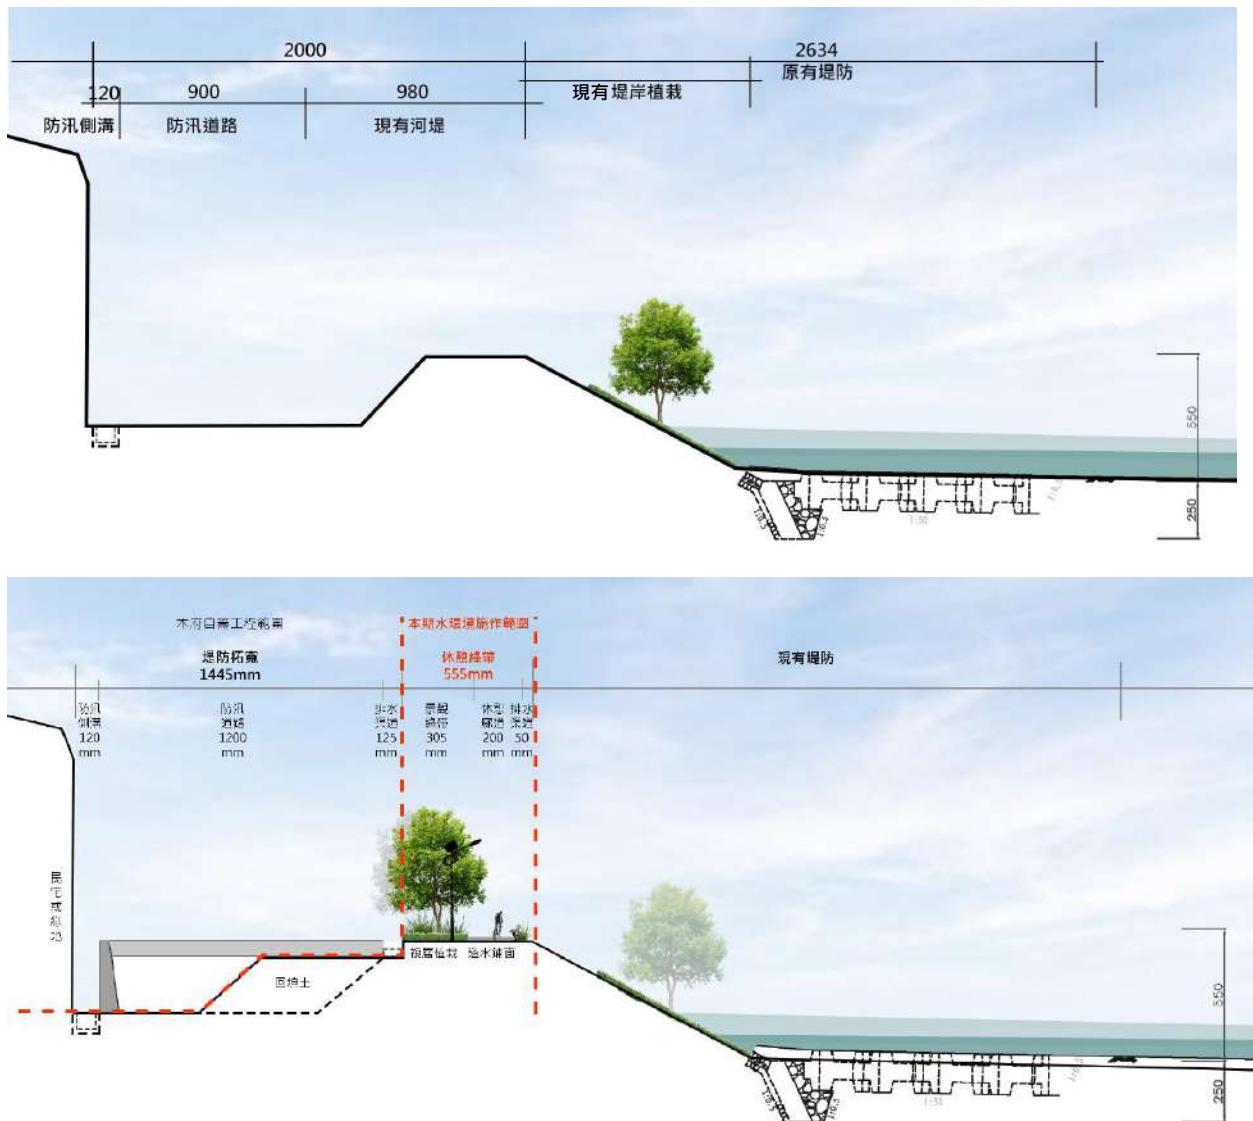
施工前(上圖)施工後(下圖紅色虛線範圍)對照剖面式意圖
